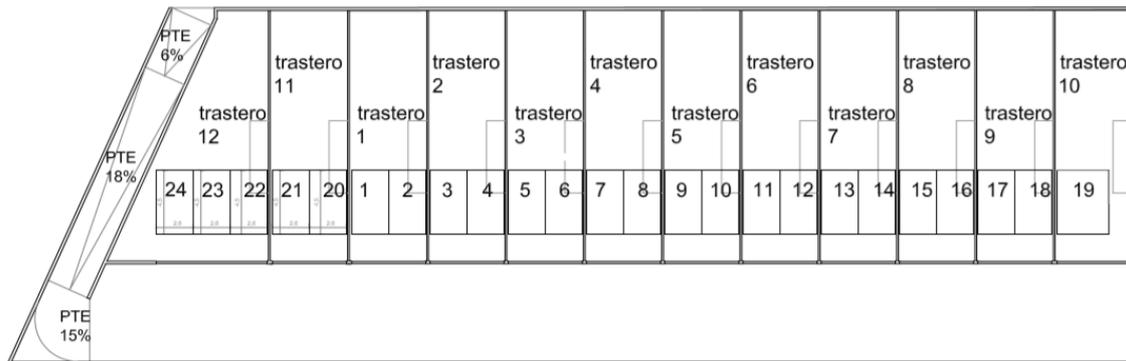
Planta sótano de la promoción de 12 adosados con garaje. Fuente: elaboración propia
